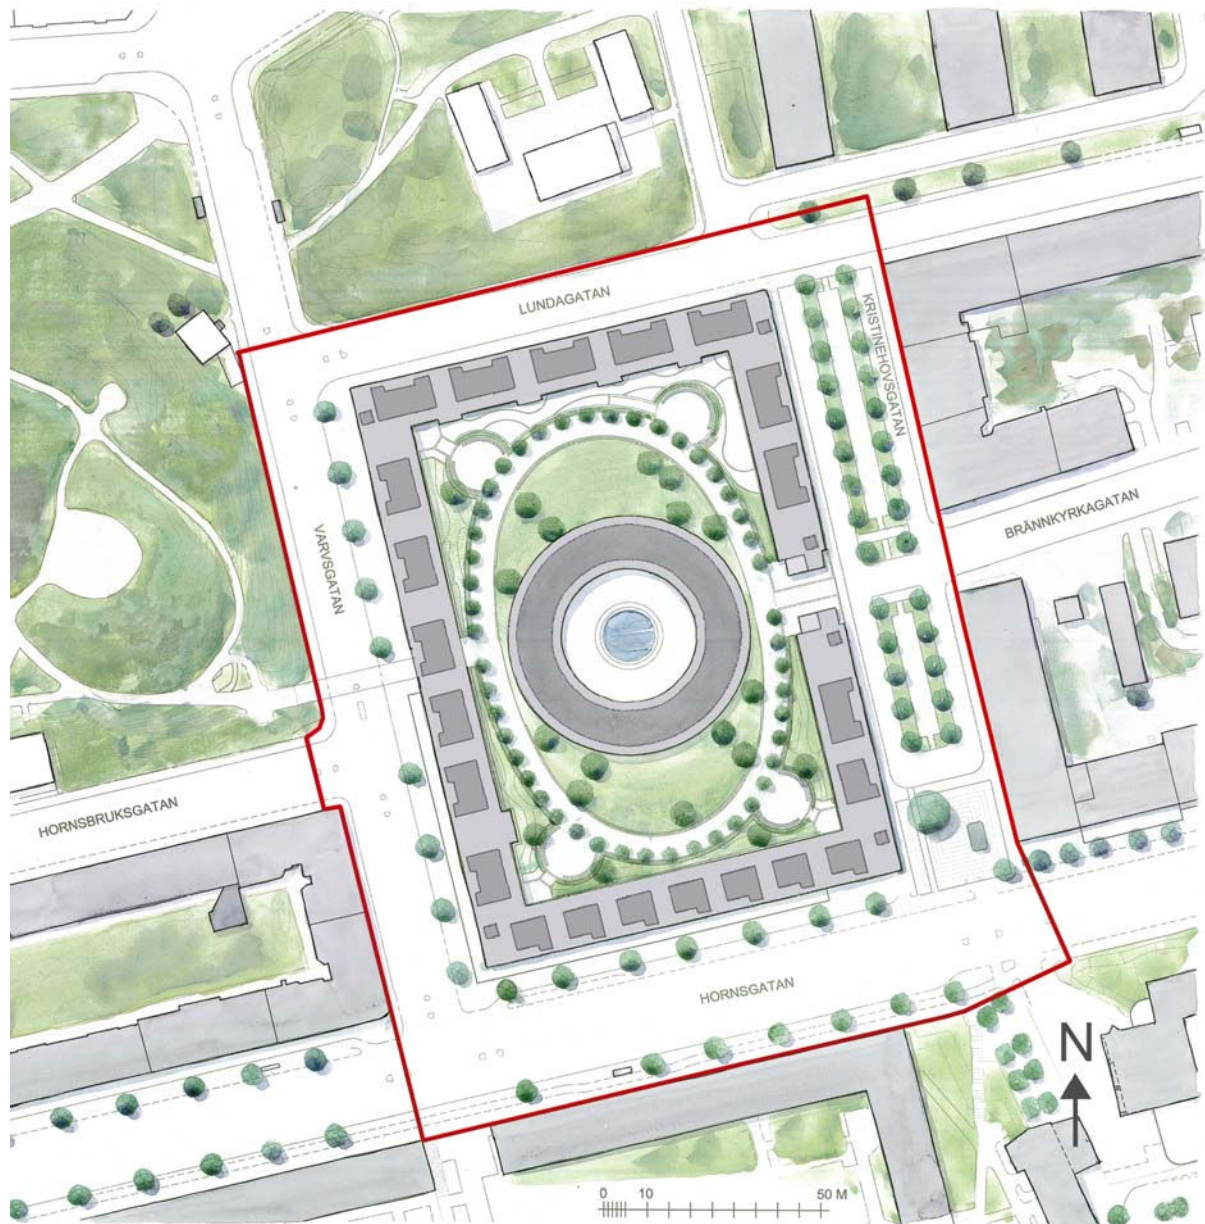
Illustrationsplan över planförslaget. Den röda linjen utgör plangräns.
